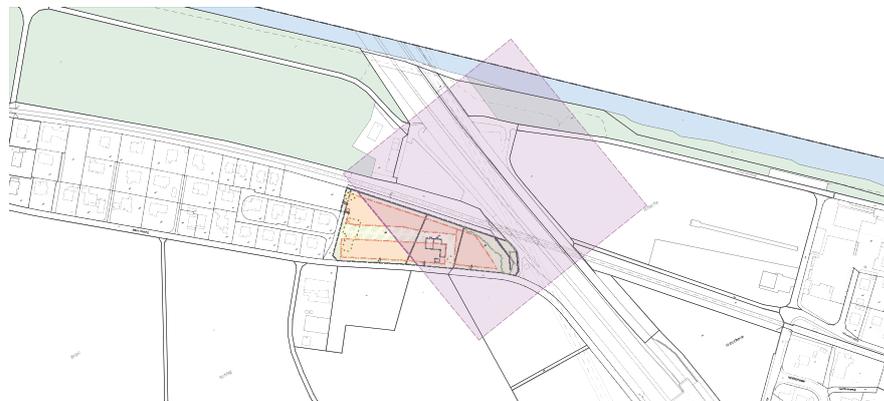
Überbauungsplan mit Scanner-Zelle 200 m x 200 m (rosa Fläche)
